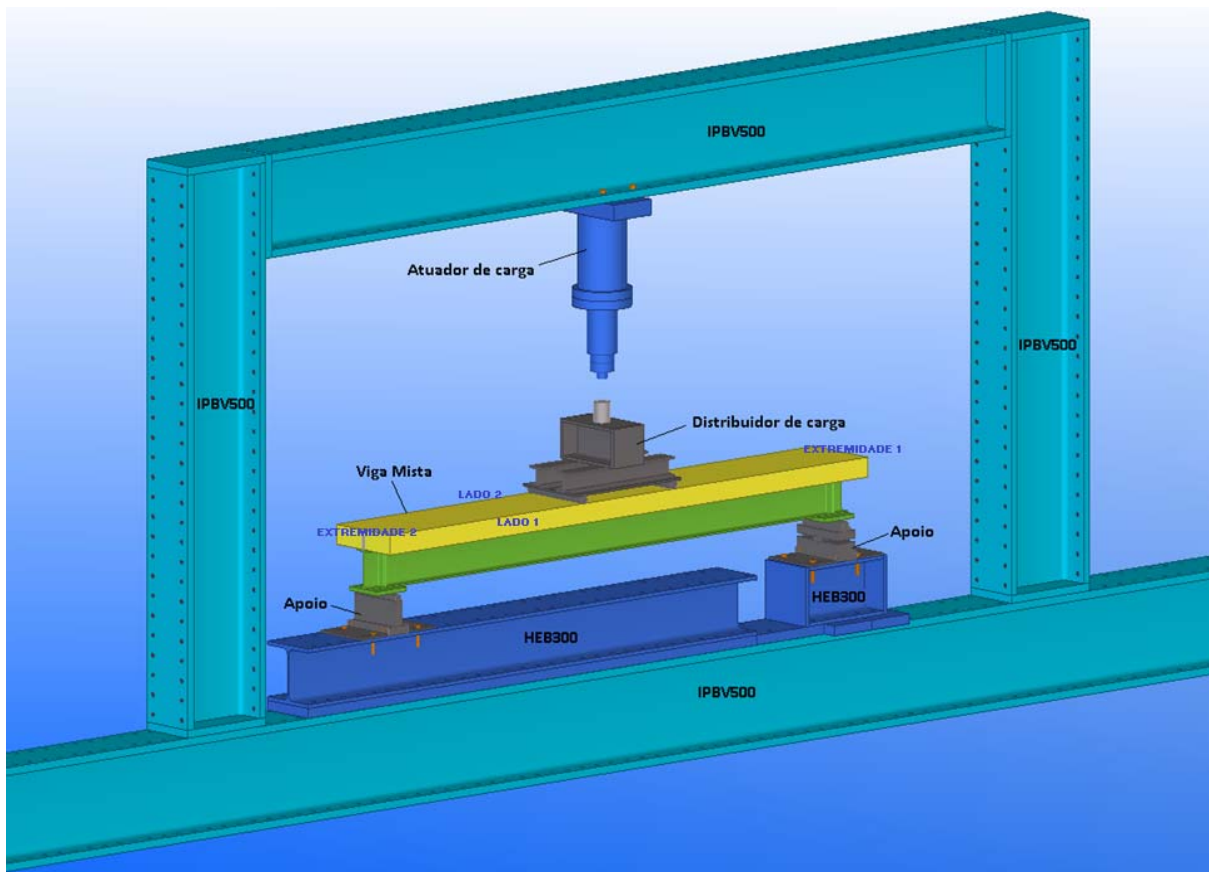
Pórtico do ensaio e disposição do ensaio
